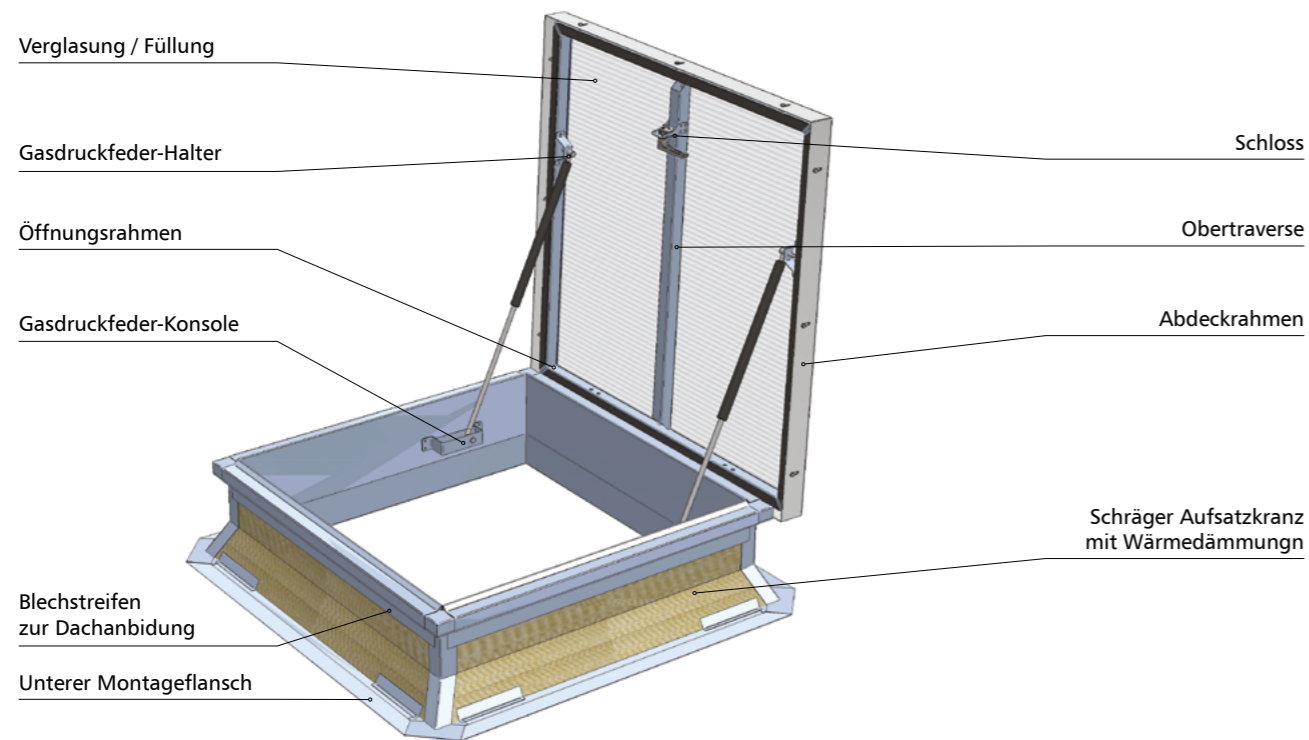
Aufbau des Dachausstiegs mcr PROLIGHT NG-A
